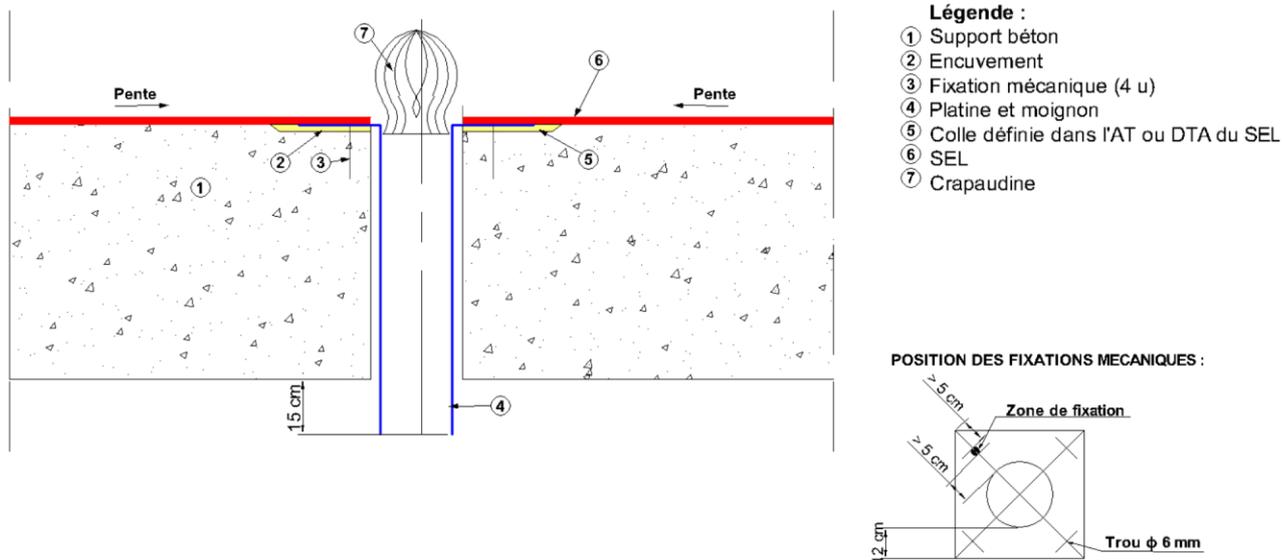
Exemple de traitement d'une évacuation d'eau pluviale avec platine
